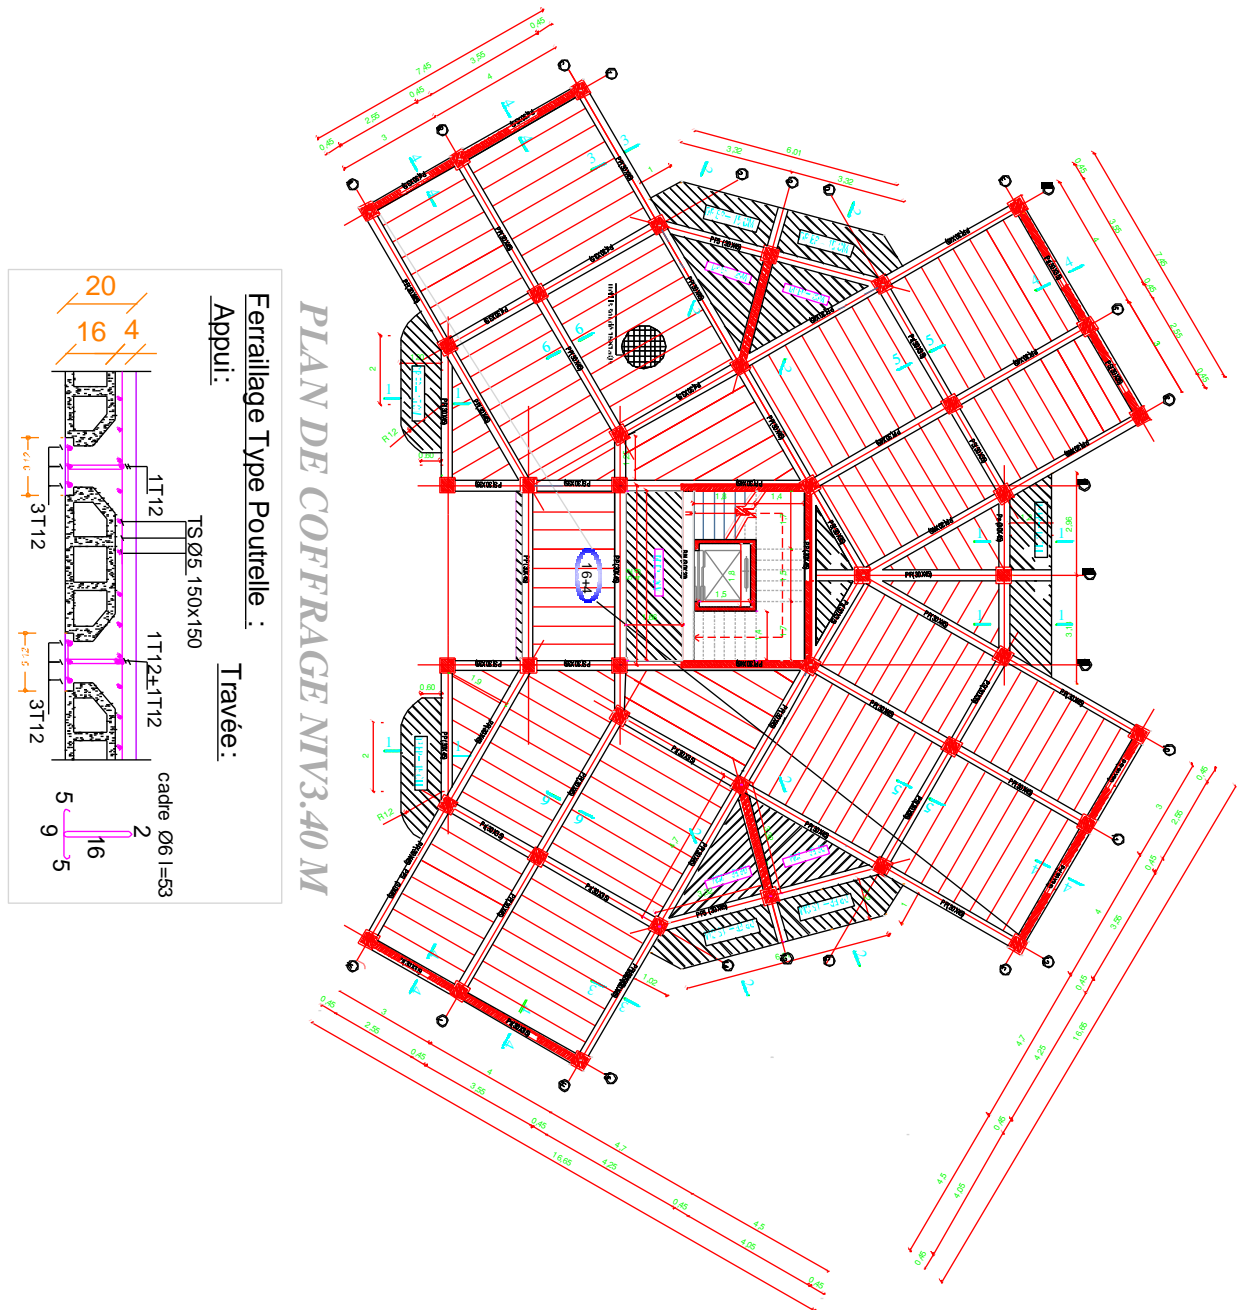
Coffrage et Ferrailage De Plancher RDC
